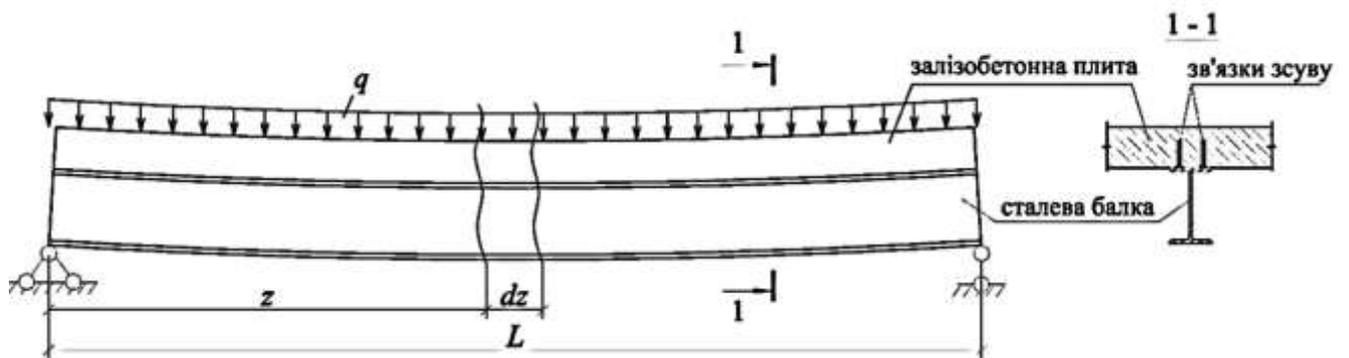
Загальний деформований вигляд двошарової сталезалізобетонної стержневої конструкції, що працює на поперечний згин
